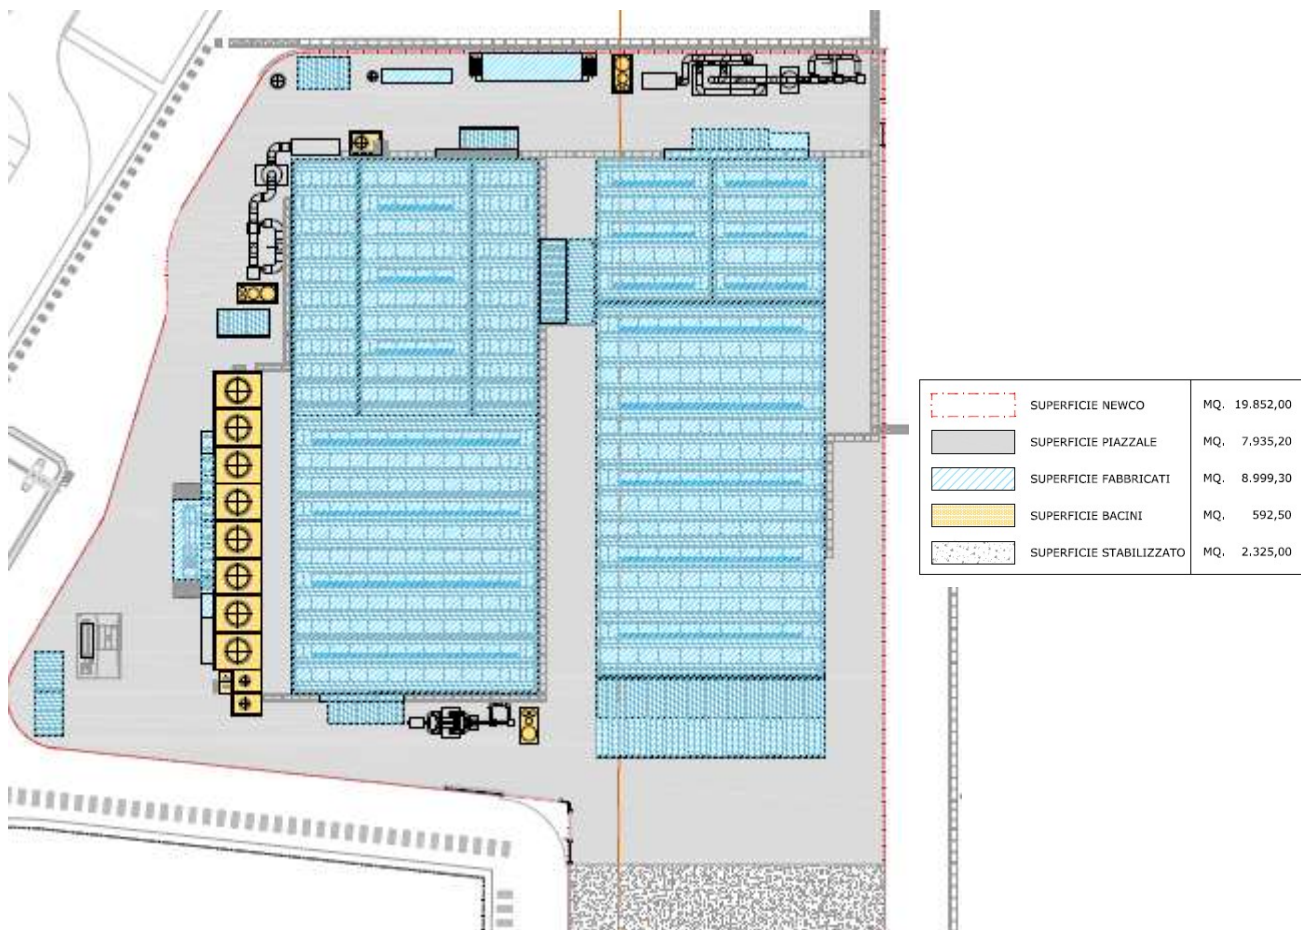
Planimetria generale delle coperture ( Stralcio Elaborato El.39.00_CO 05 RA VA 00 D1 PL 39.00 - PLANIMETRIA GENERALE COPERTURE)
